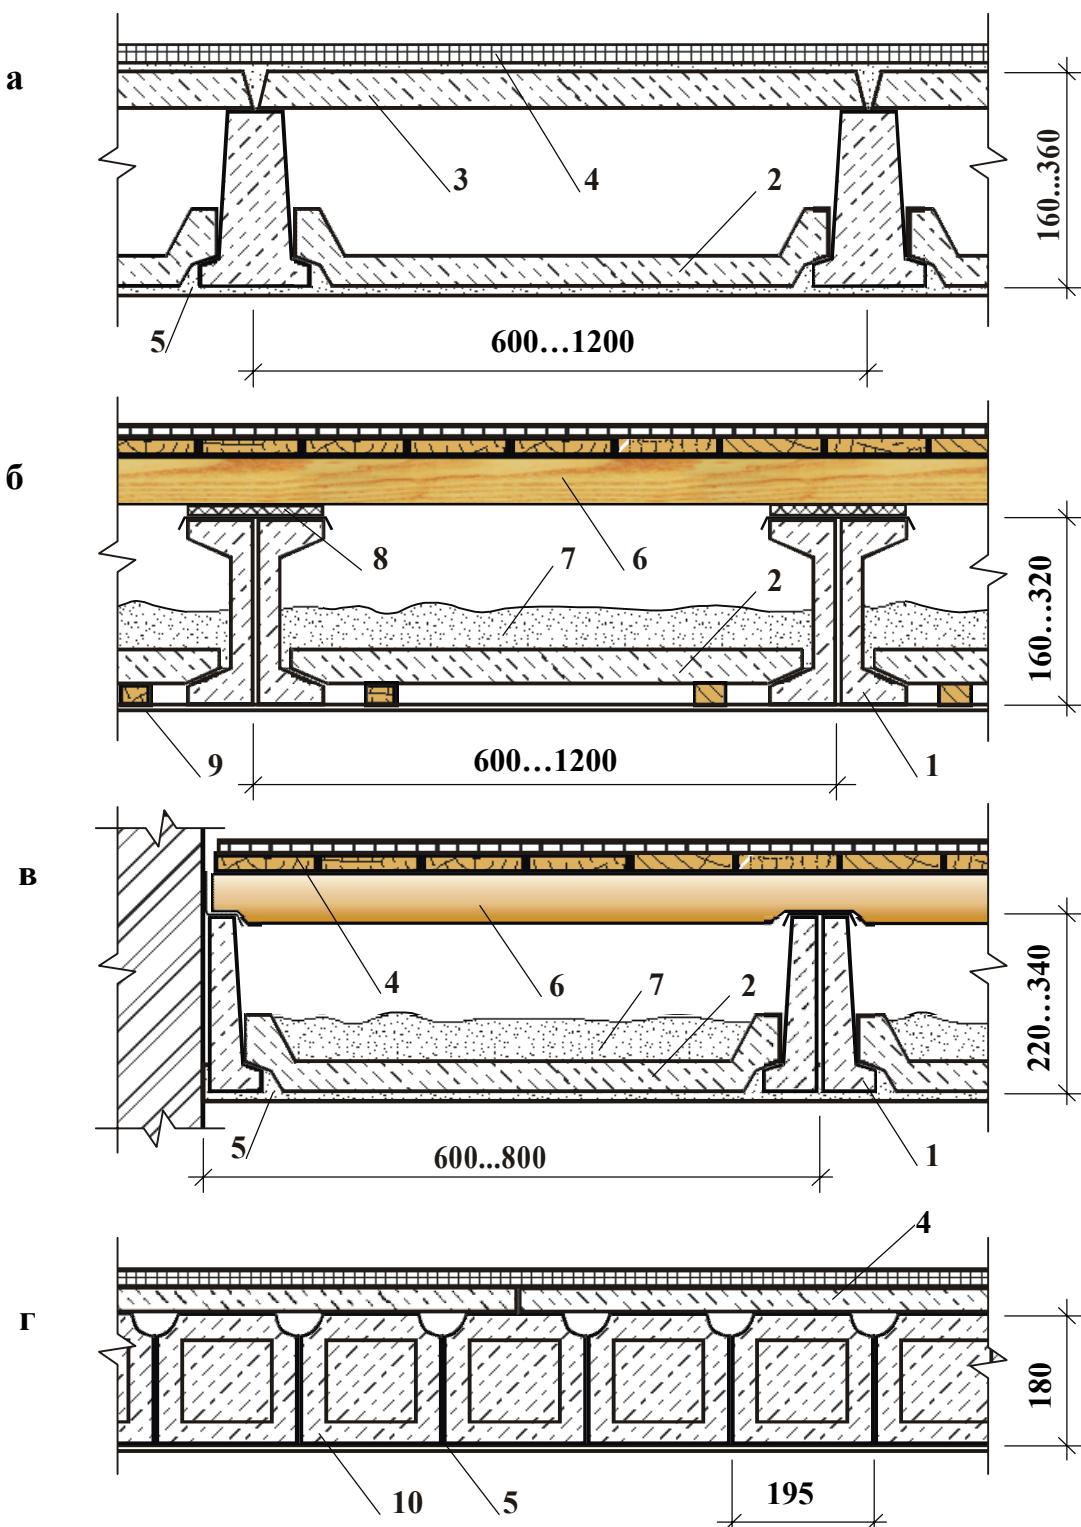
Збірні залізобетонні перекриття по балках:
